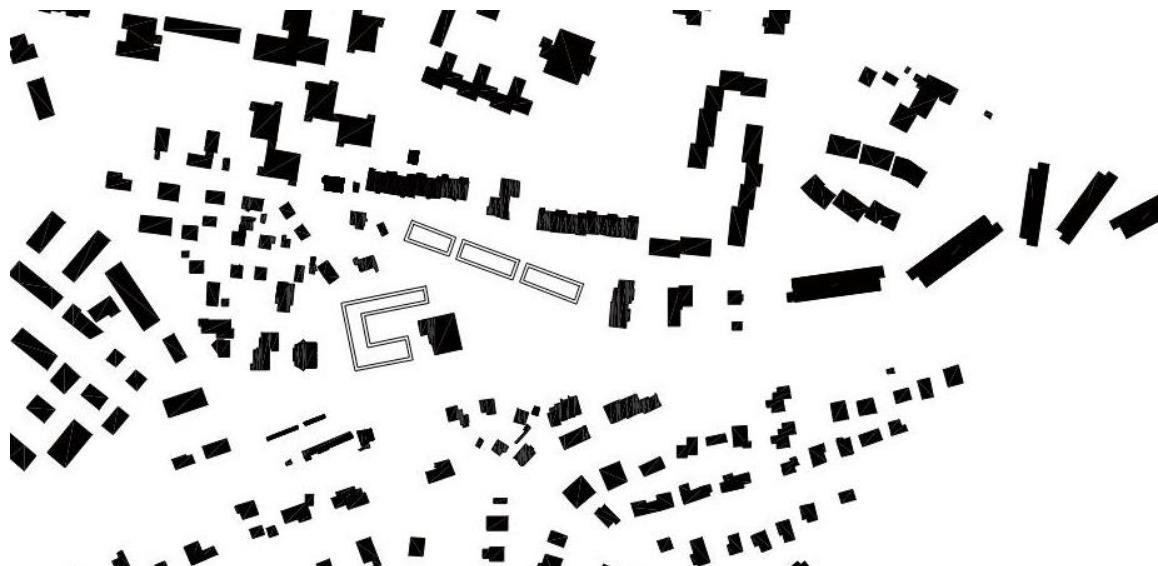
Situationsplan mit 2 Bauetappen und Werkstatt-Gebäude Bestand
